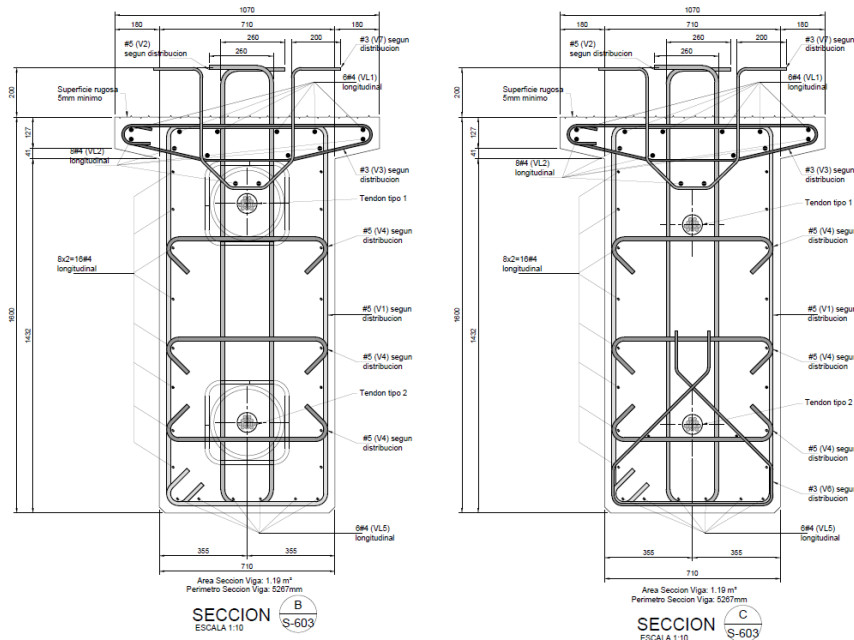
Detalle de refuerzo en zona n.º 1 de viga de superestructura n.º 4
